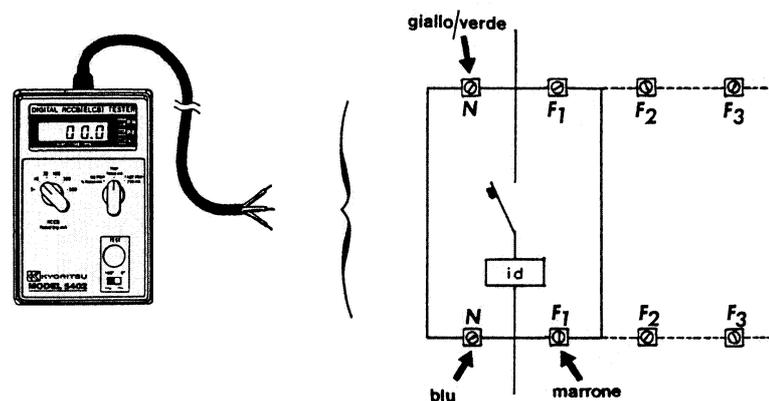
Collegamento diretto all'interruttore differenziale su un impianto con tensione 400/230 V.
